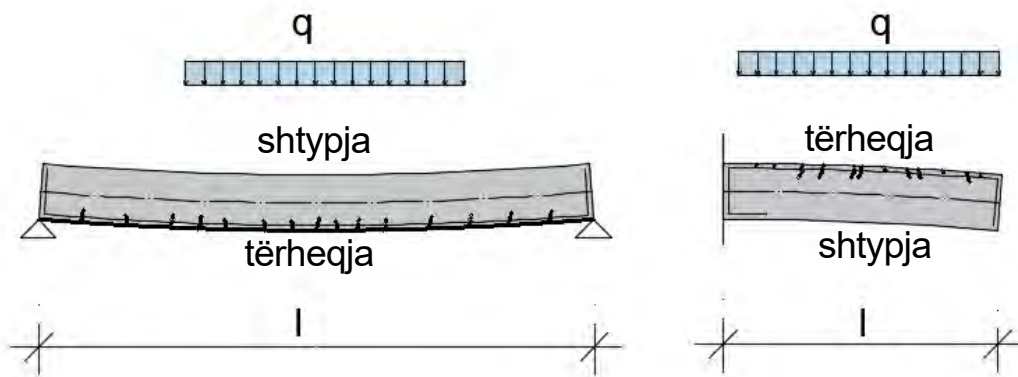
Roli i betonit dhe armaturës në elementet prej betonit të armuar
